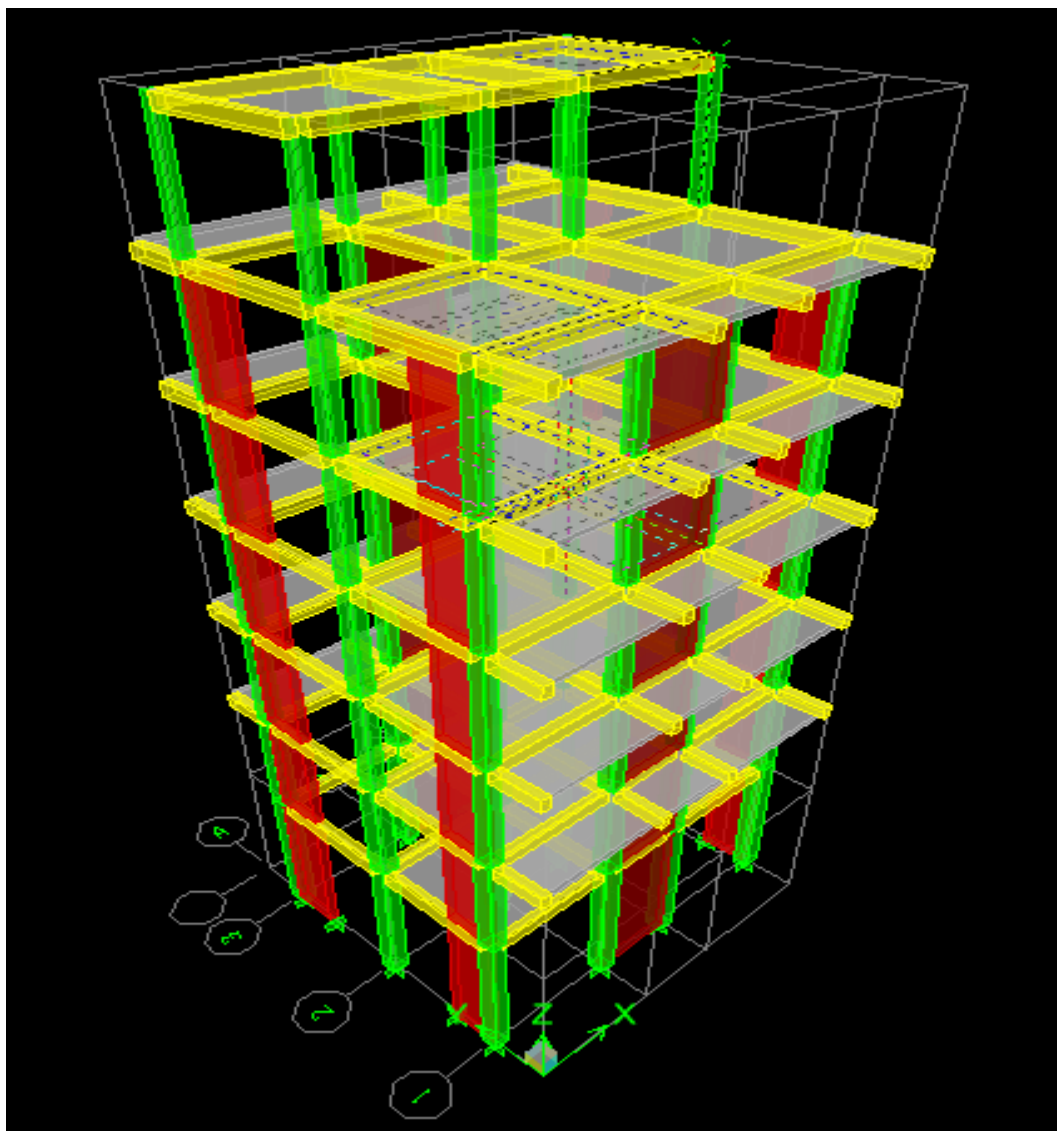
Vue en trois dimensions du plan de l'ouvrage
